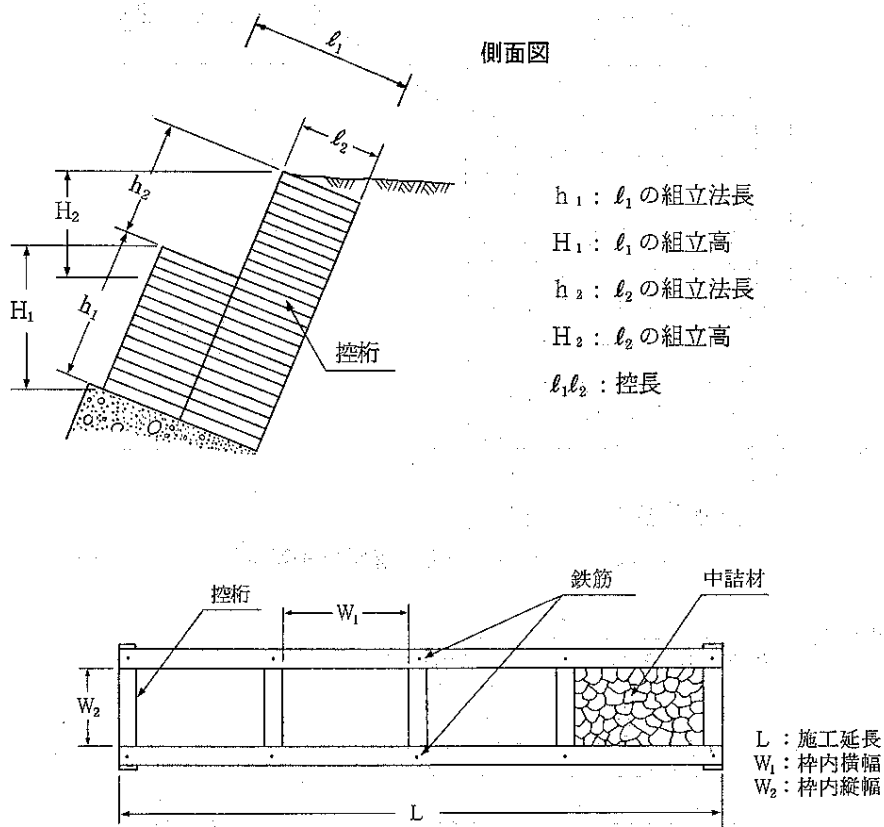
3 8 鉄筋による組立式井桁ブロック平面図
